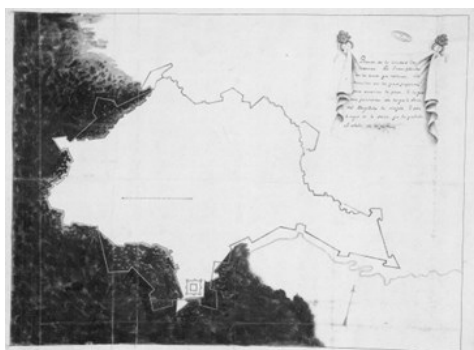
Pianta del perimetro delle fortificazioni di Catania e progetto delle nuove opere (De Grunembergh)
